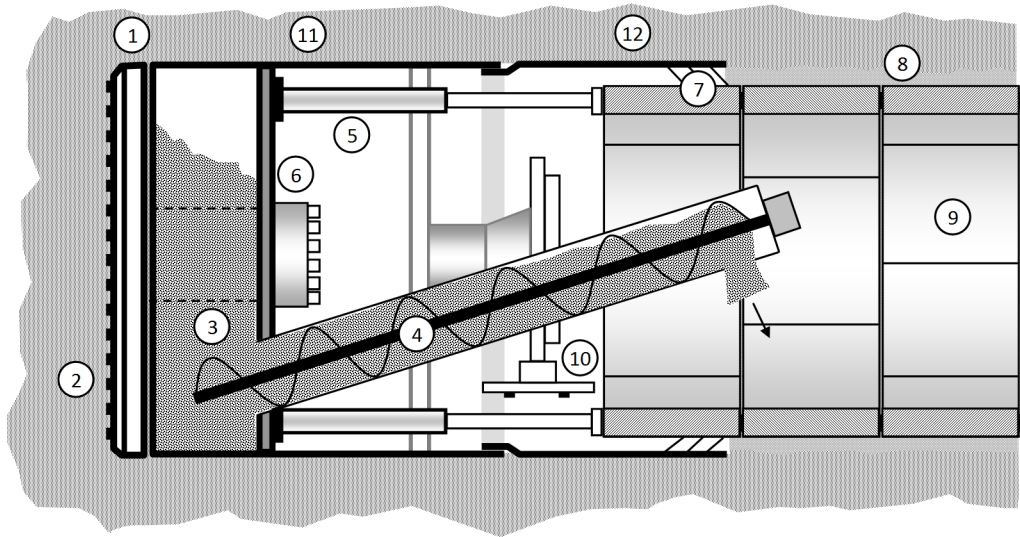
Coupe schématique d'un tunnelier à pression de terre.
